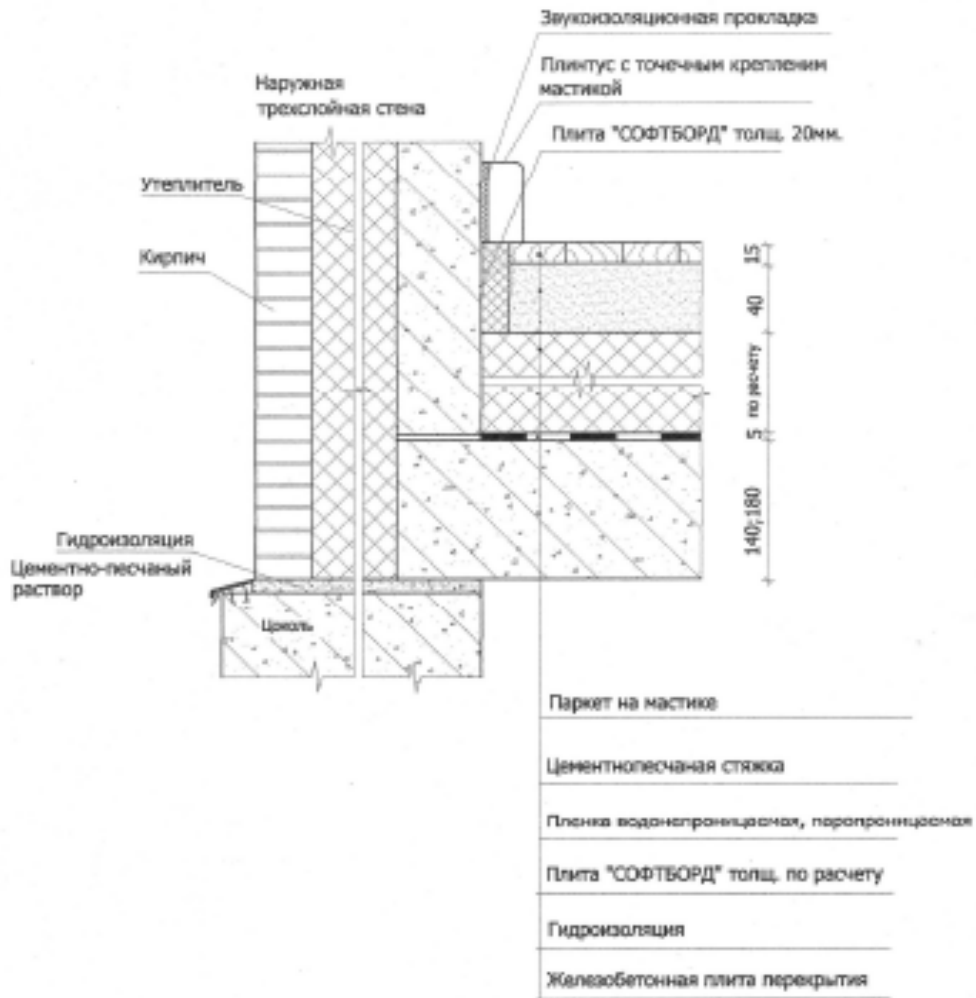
Конструкция пола над подвалом и стыка его с наружной стеной
